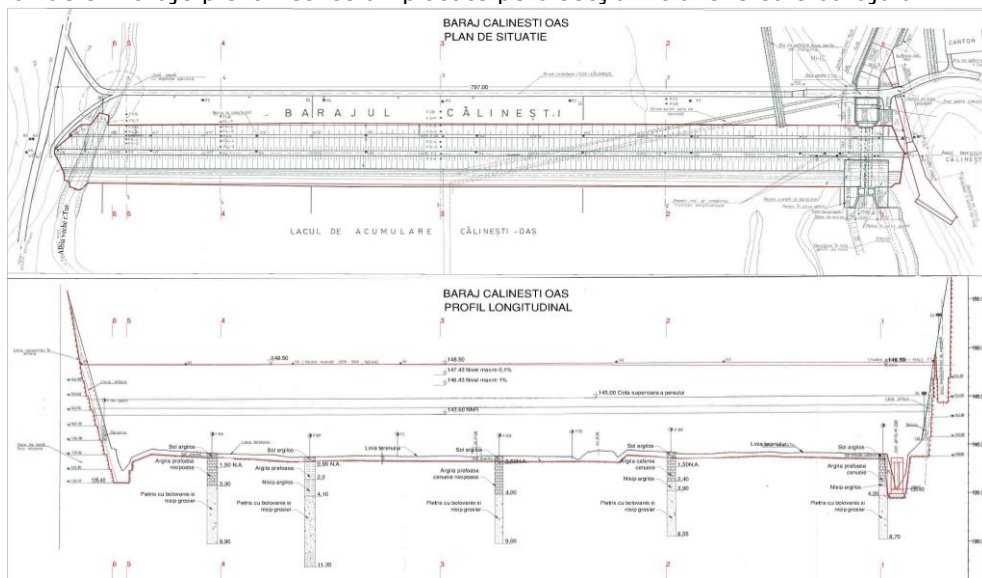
Plan de situație și profil longitudinal Călinești Oaș
